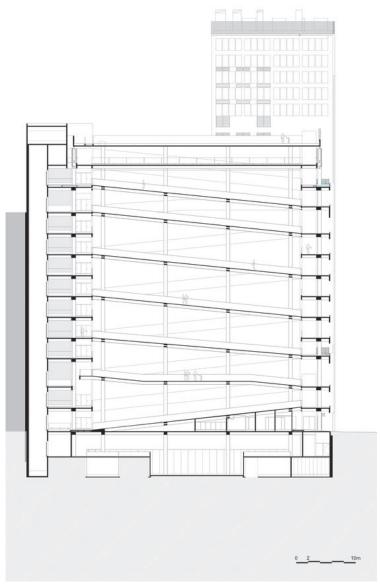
Corte BB SESC 24 de Maio, Sao Paulo. Fuente: Mendes da Rocha + MMBB Arquitectos.
